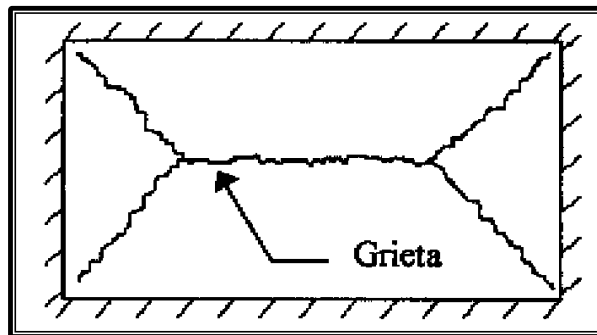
grietas a 45 grados unidas por una grieta longitudinal, en la cara inferior de la losa. (Falla por la flexión de la losa rectangular apoyada en los cuatro bordes).
